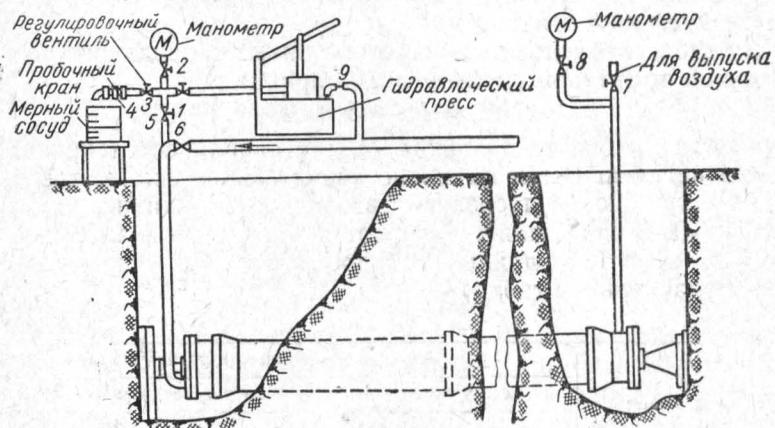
Схема опрессовочного узла при гидравлическом испытании трубопроводов.
